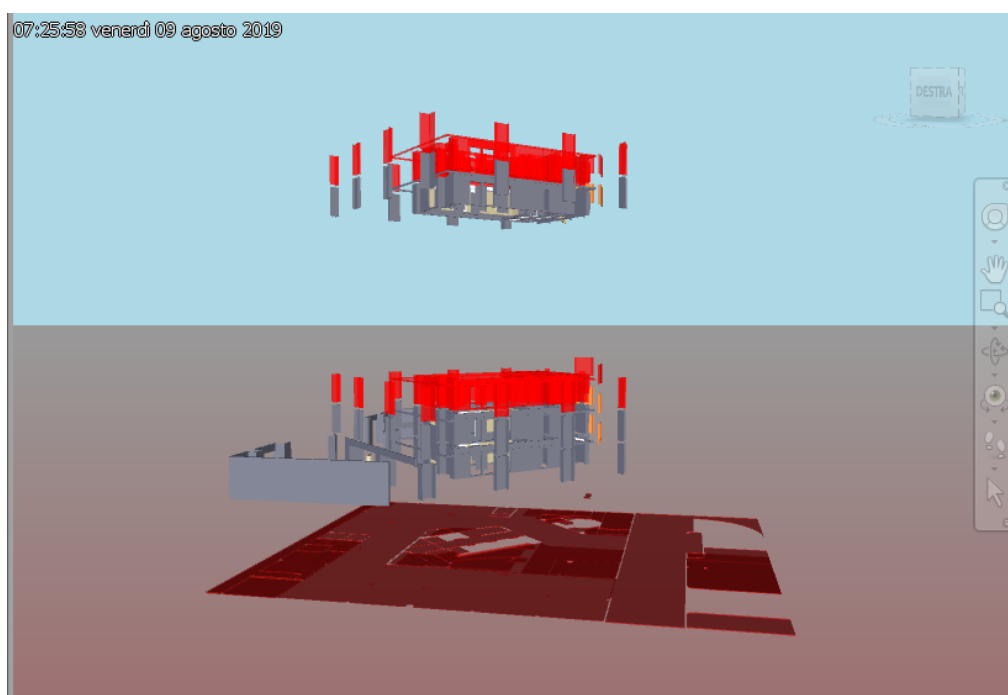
Simulazione 4D - Elevazione muri P3, P10 e montaggio serramenti P9 (Navisworks)
